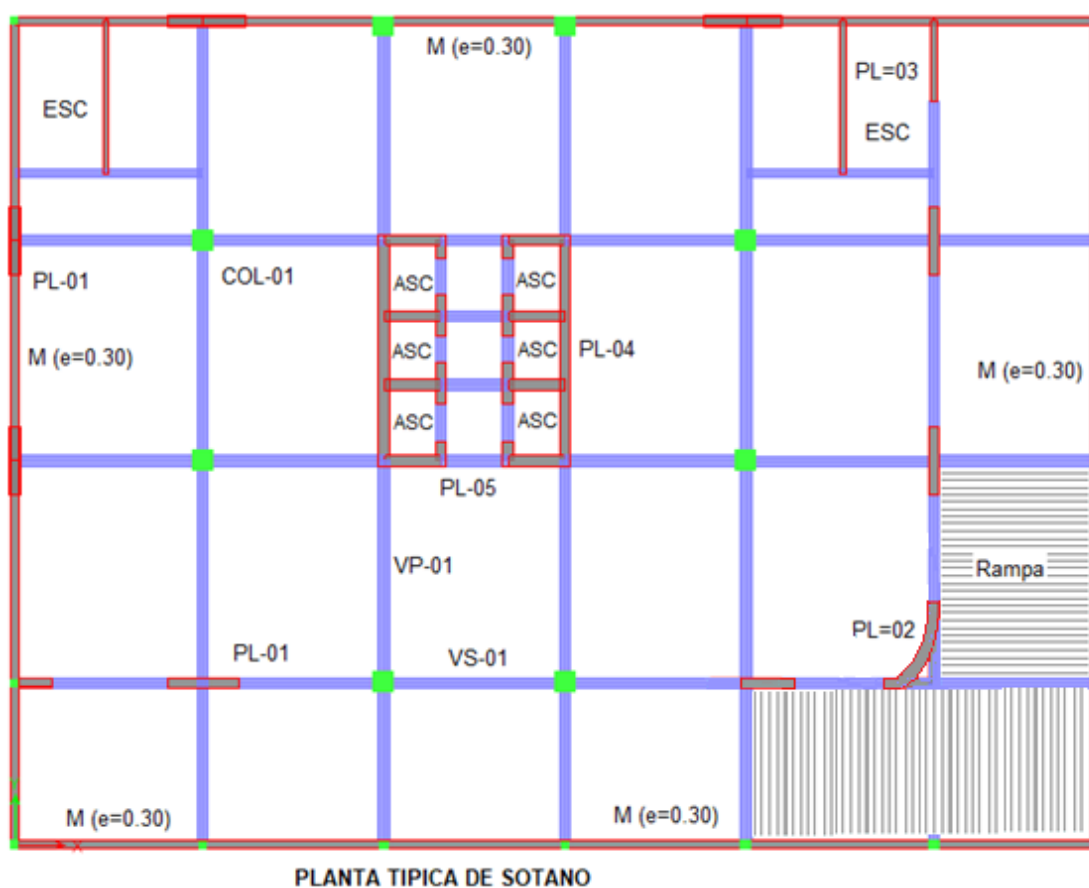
Esquema de Estructuración en Planta - Sótano 1 @ Sótano 3
